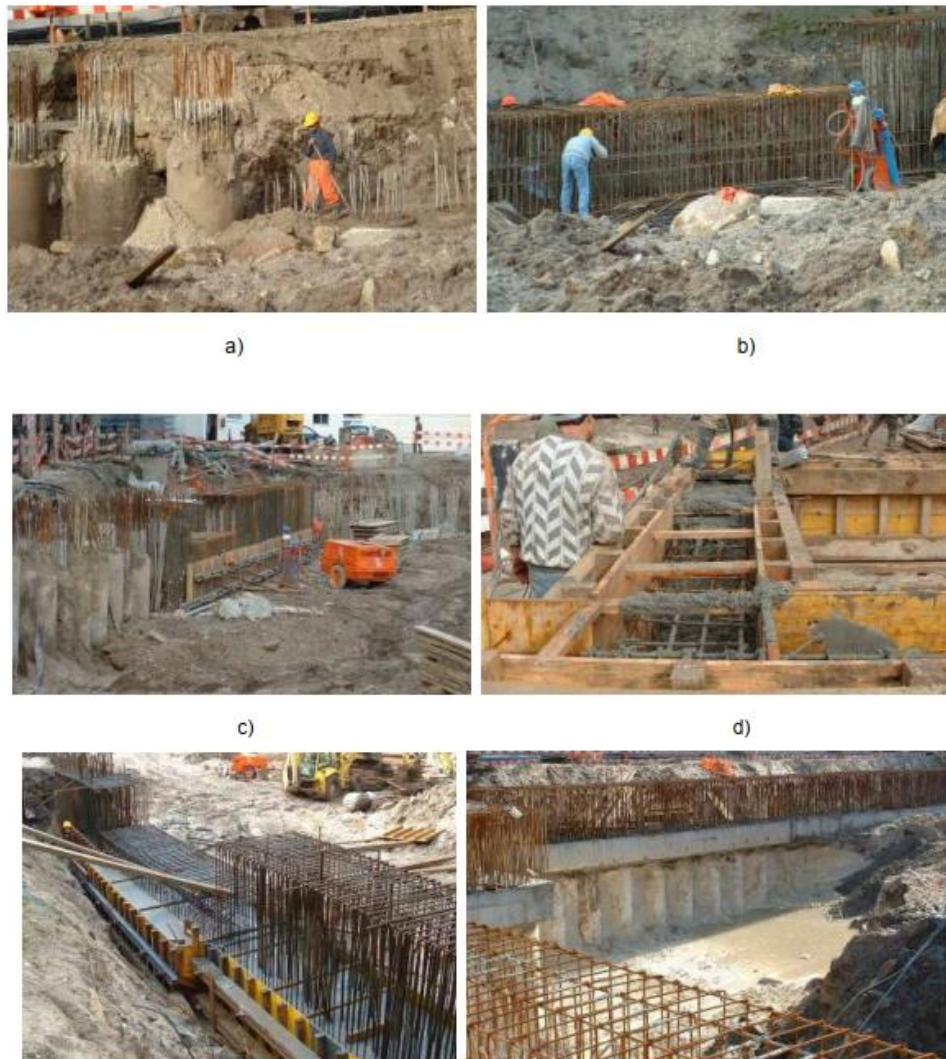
Execução da viga de coroamento na Estação de Metro dos Aliados: a) saneamento das estacas; b) arranjo da armadura; c) construção da cofragem; d) betonagem da viga; e) aspecto da viga após betonagem; f) aspecto da viga após descofragem [26].
